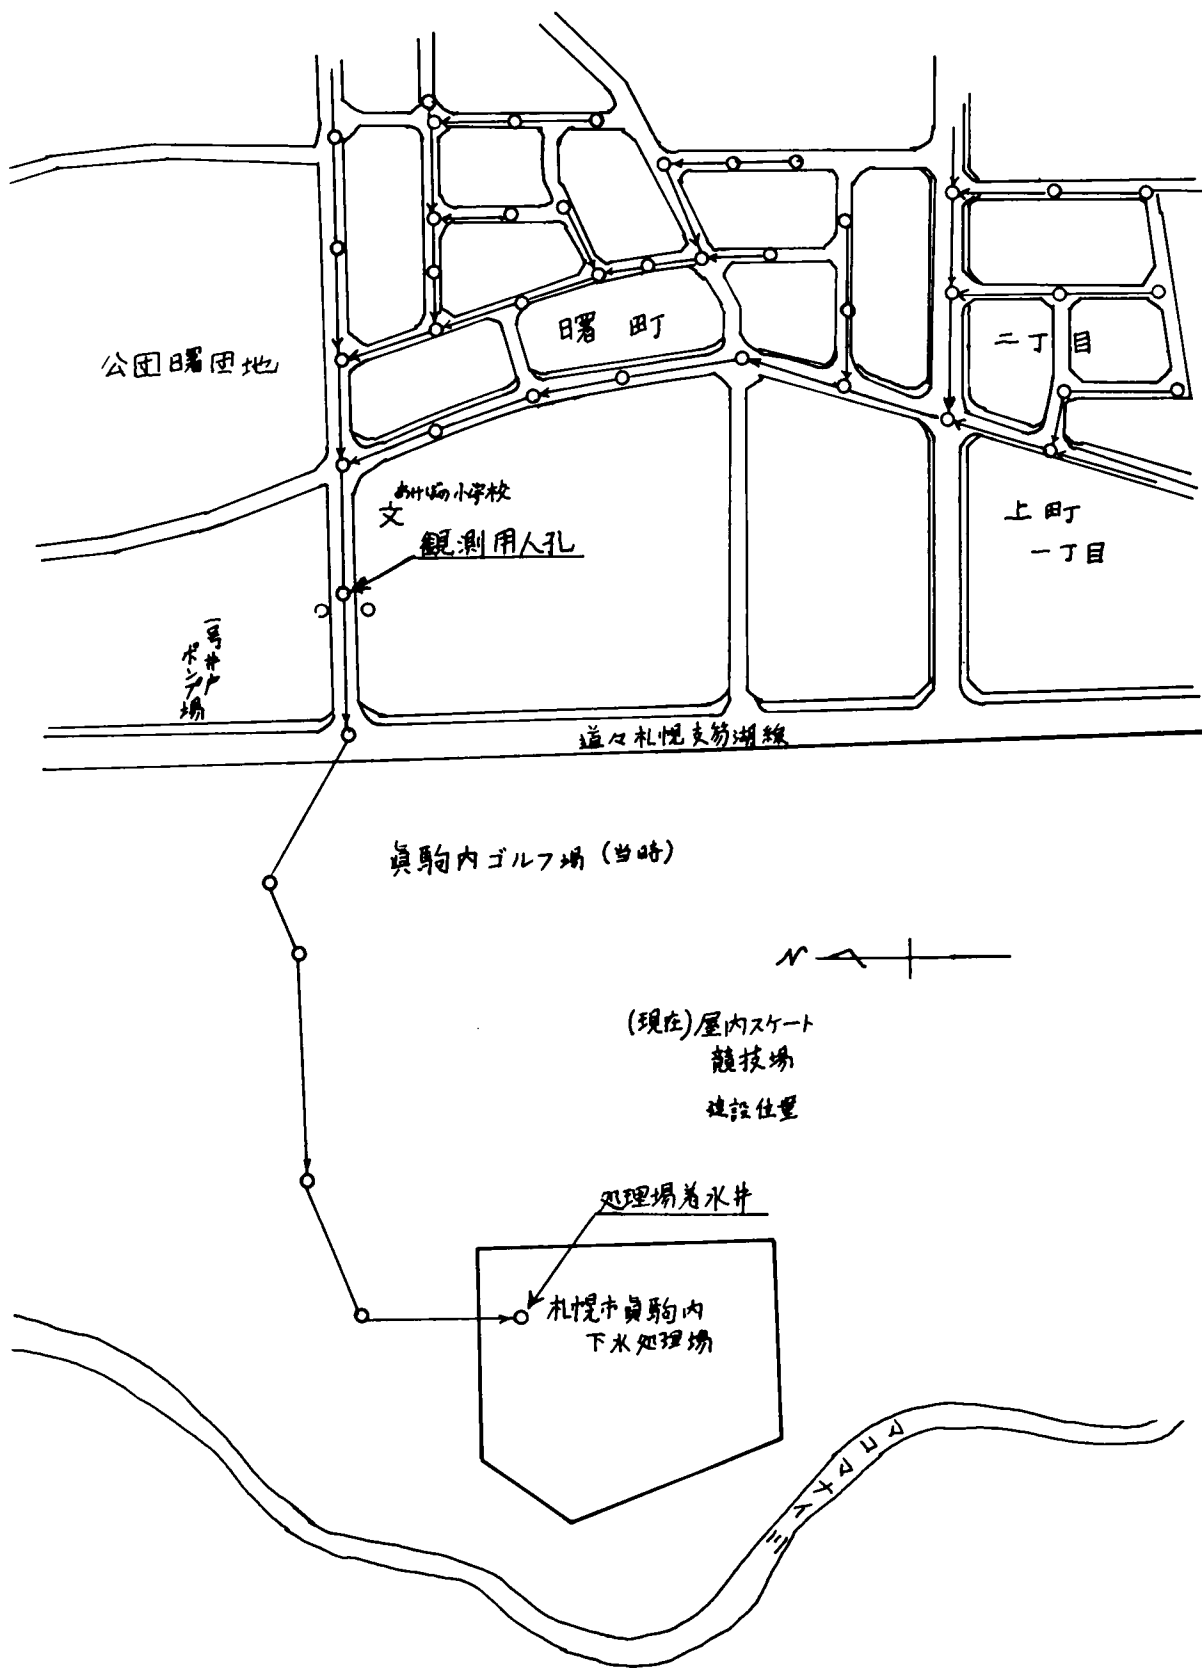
真駒内団地下水道(汚水管)平面図 1/5000
